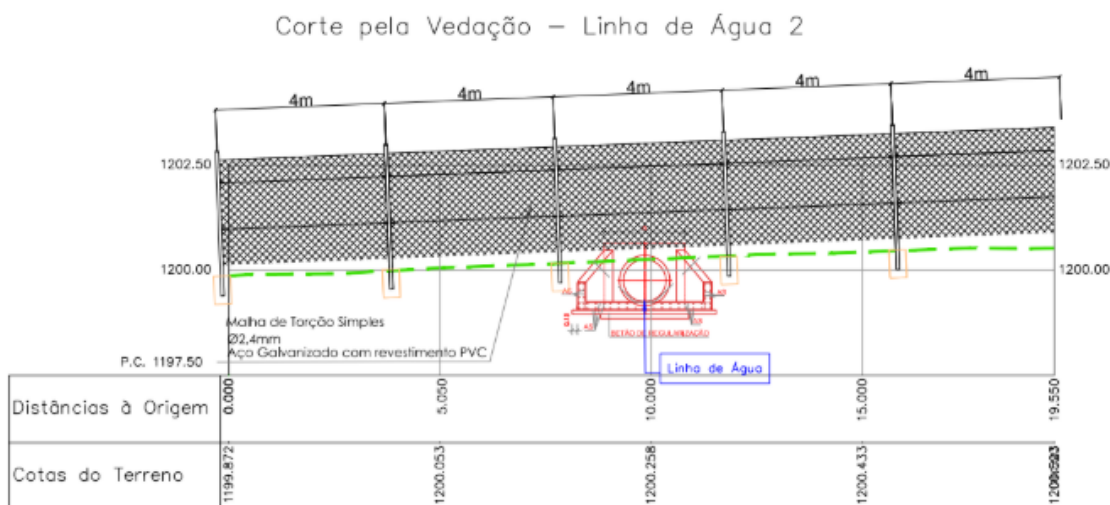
Perfil transversal à linha de água correspondente ao atravessamento situado mais a sul.
